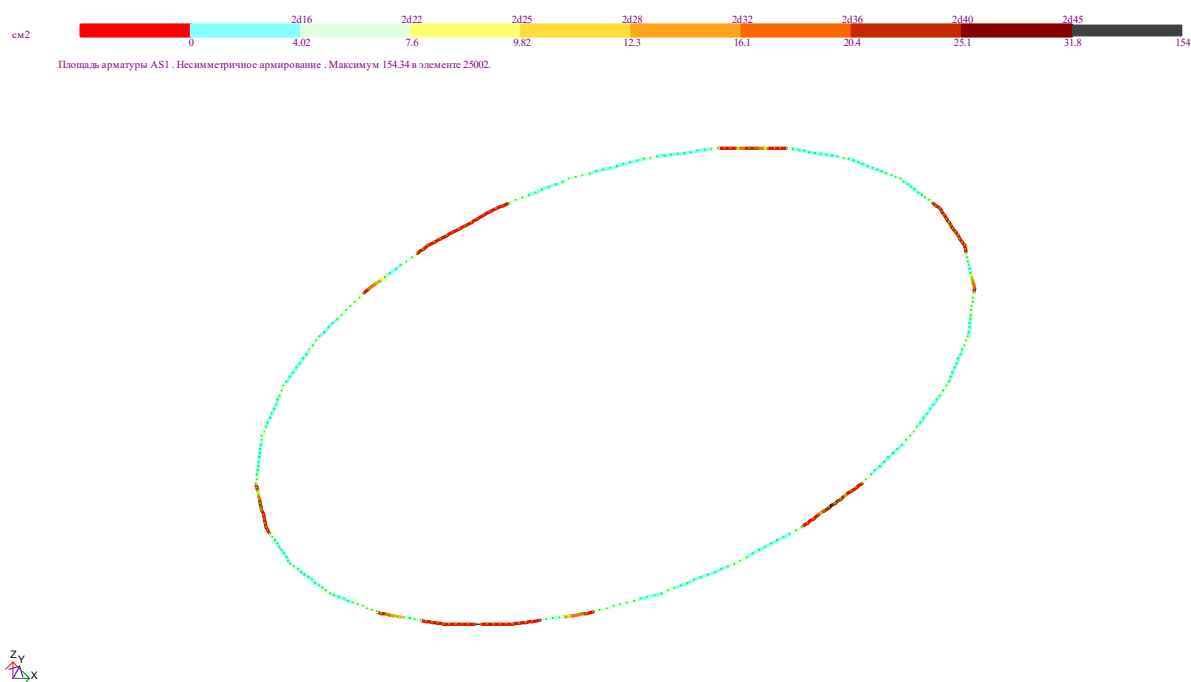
Нижнє армування у середній частині залізобетонного ригелю
